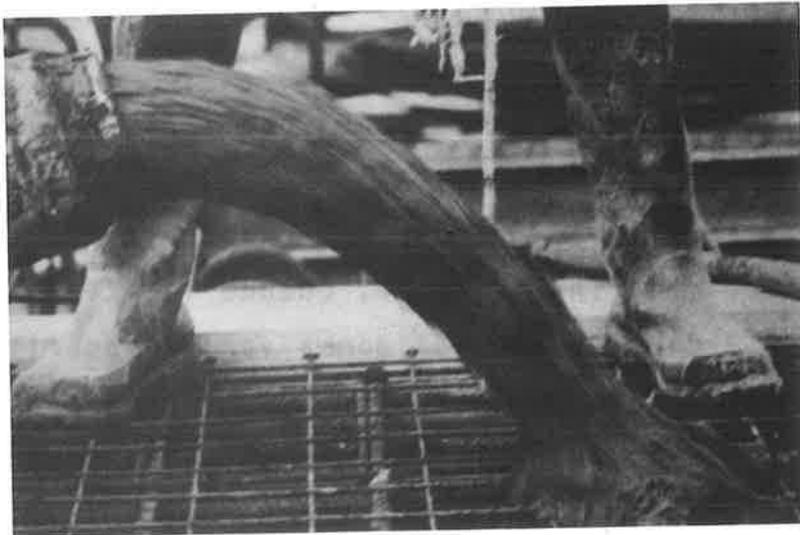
Posizionamento dei ferri di armatura sul calcestruzzo gettato in subacqueo prima del getto a cielo aperto.
